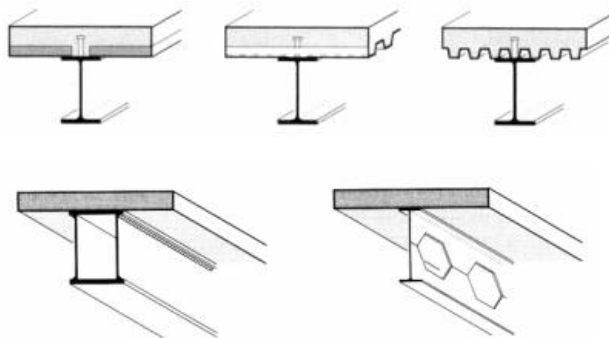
Soluções estruturais de vigas mistas (FCTUC, 2002)
